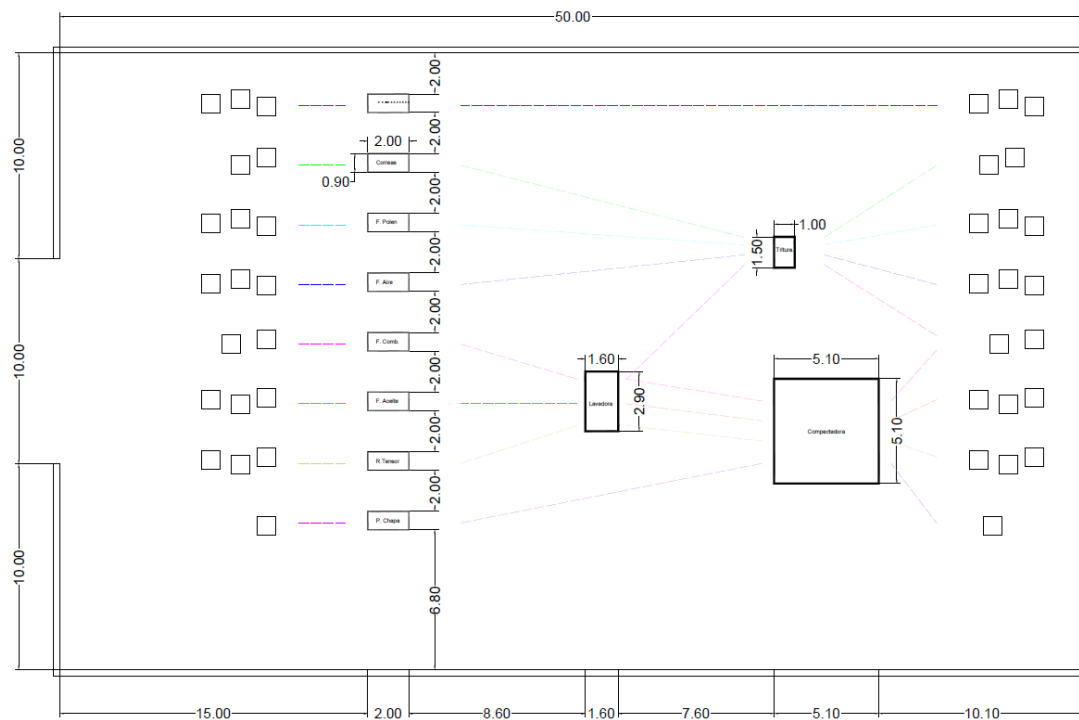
Lay out de la planta de separación y tratamiento de materiales.
